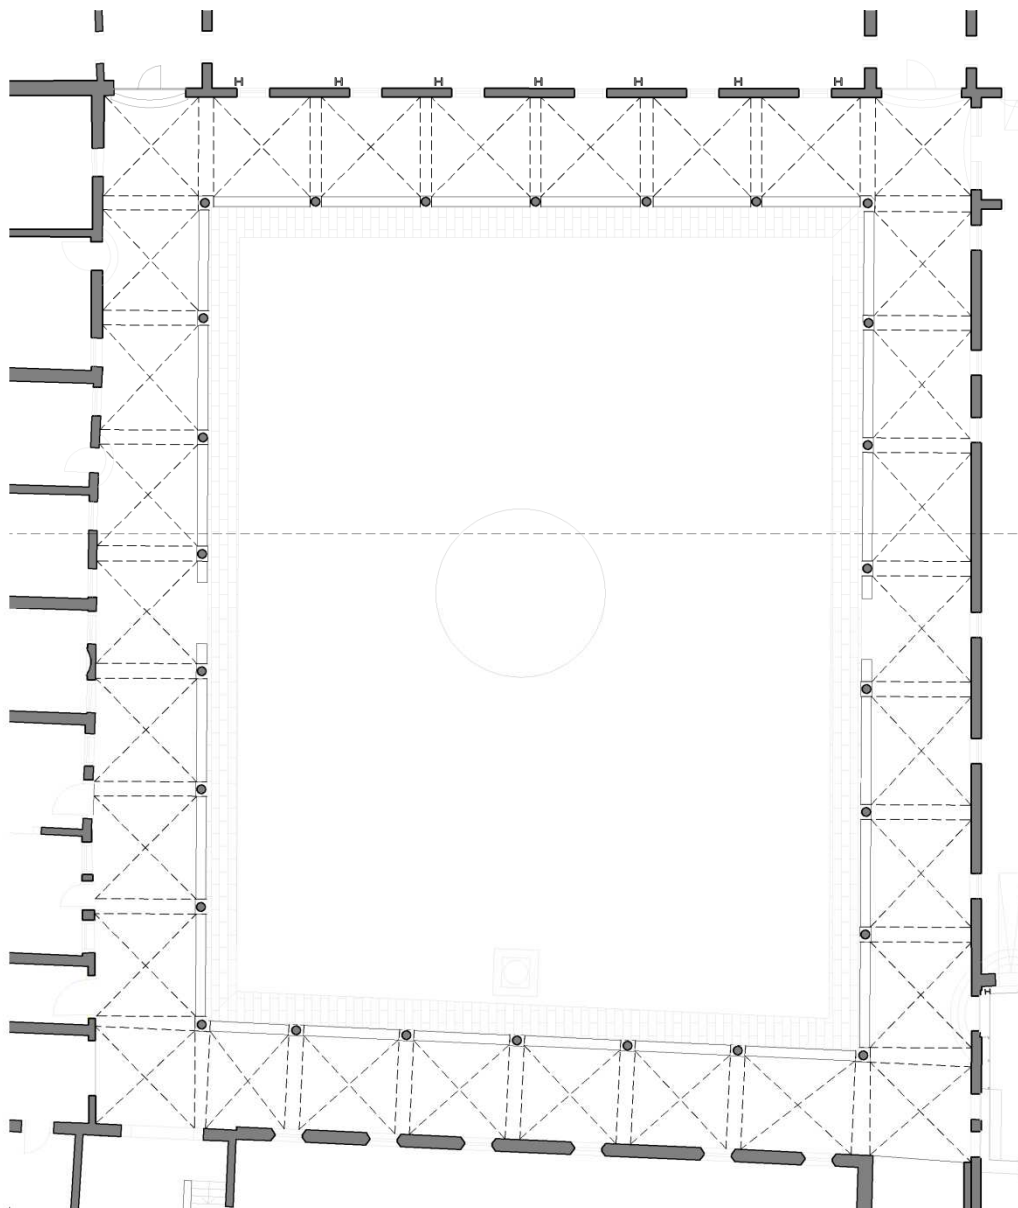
Pianta Piano Terra del Chiostro Maggiore.
